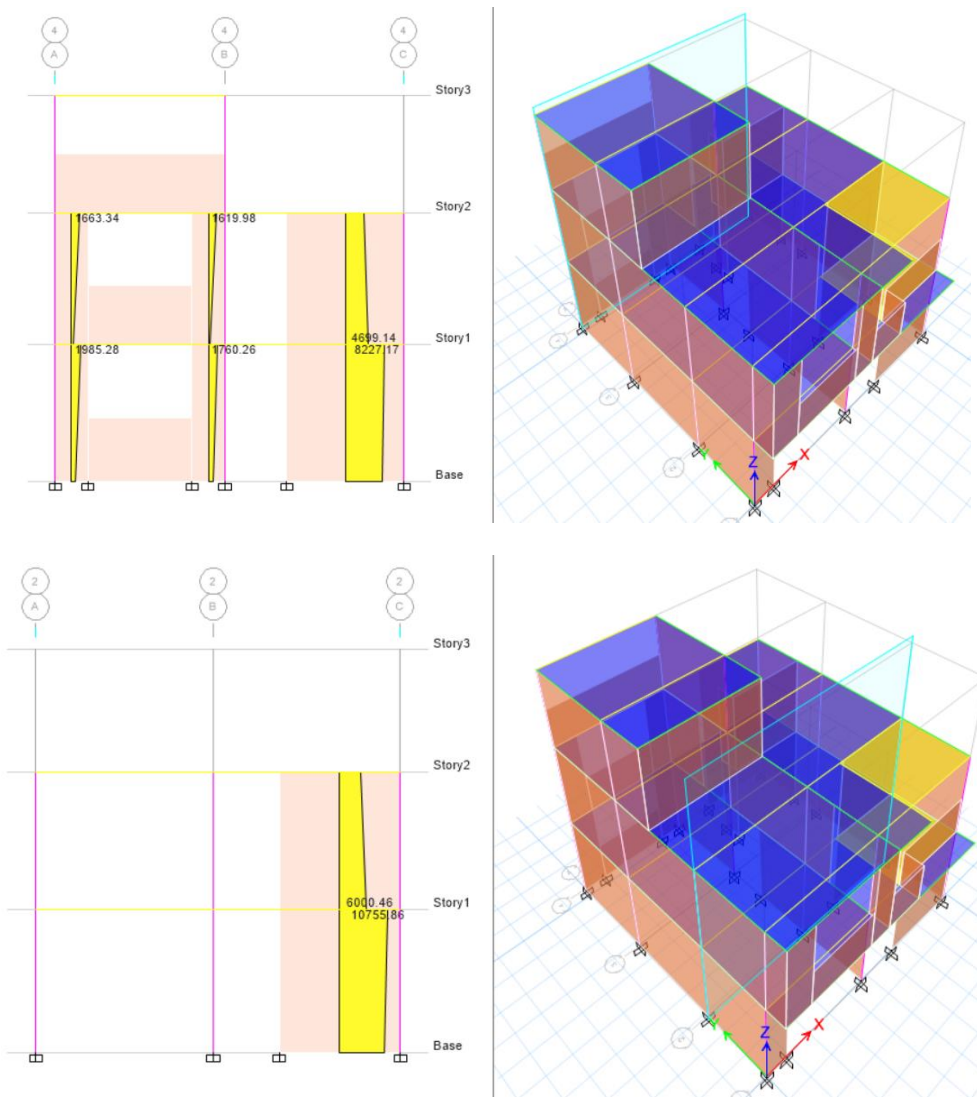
Fuerza sísmica tomada por el muro del eje 4-4 y el eje 2-2, de la vivienda sin refuerzo.
